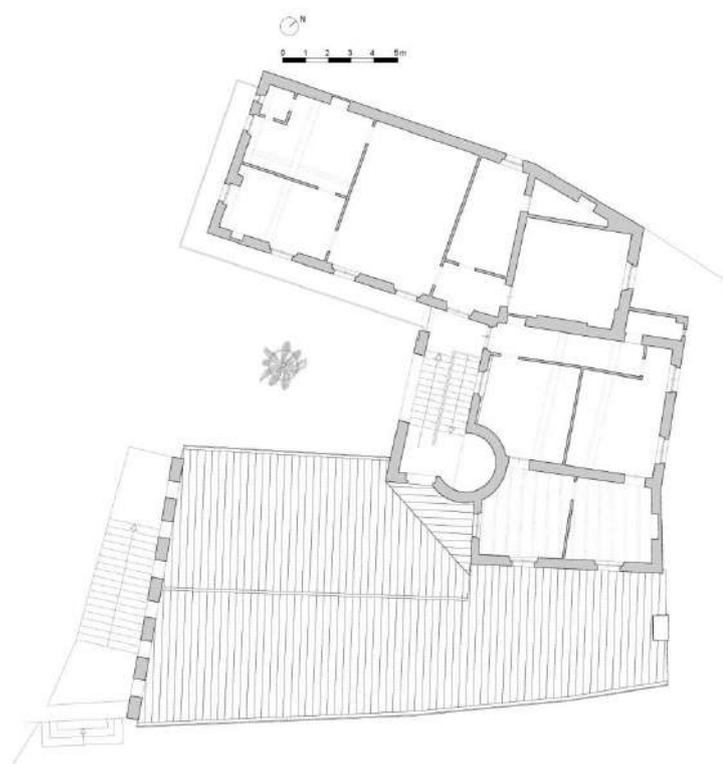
Planimetria del terzo piano del Palazzo Acaja
